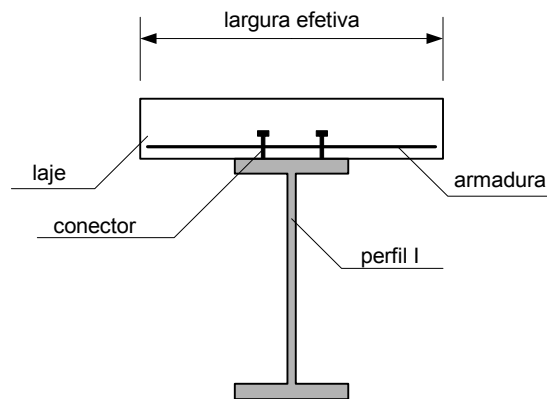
Representação de uma viga mista do tipo aço-concreto.
